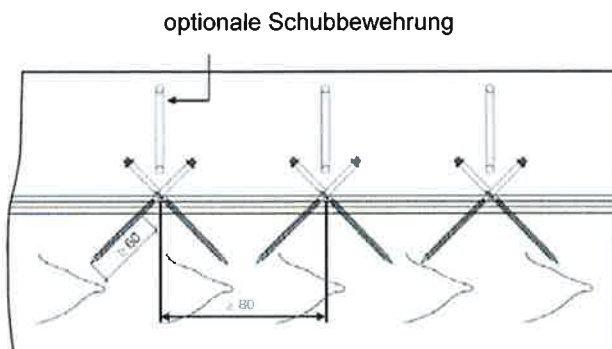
Ansicht einer Holz-Beton-Verbundkonstruktion mit SFS VB Schrauben
